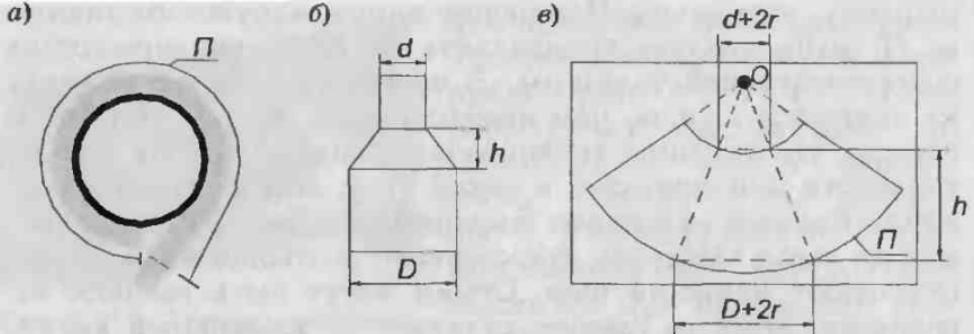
Изготовление заготовки для тепловой изоляции перехода: а — измерение наружных диаметров перехода; б — измерение диаметров перехода; в — разметка на пластине
